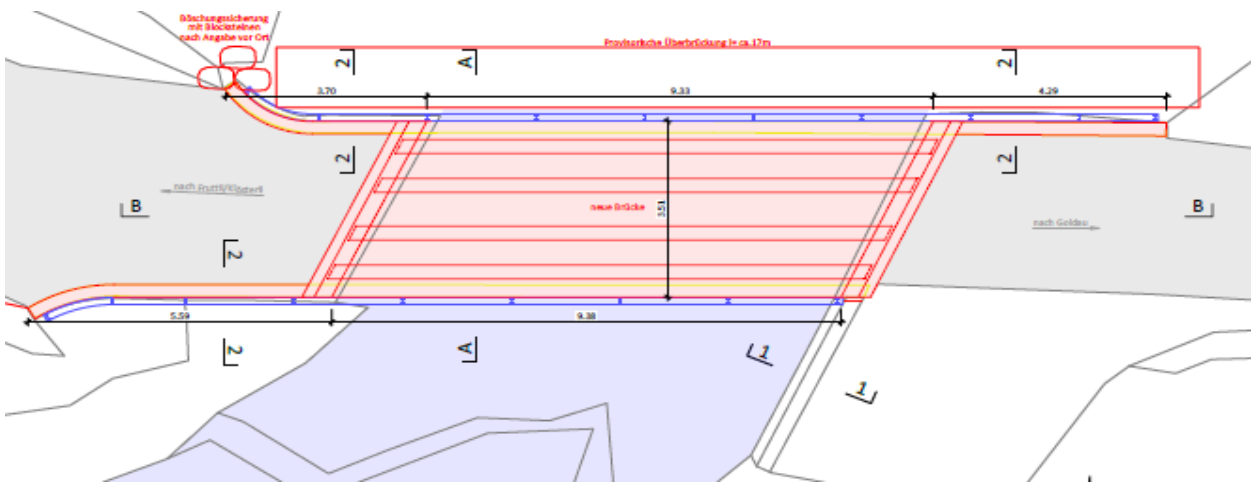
Grundriss der Brücke (Quelle: E. Kälin)
